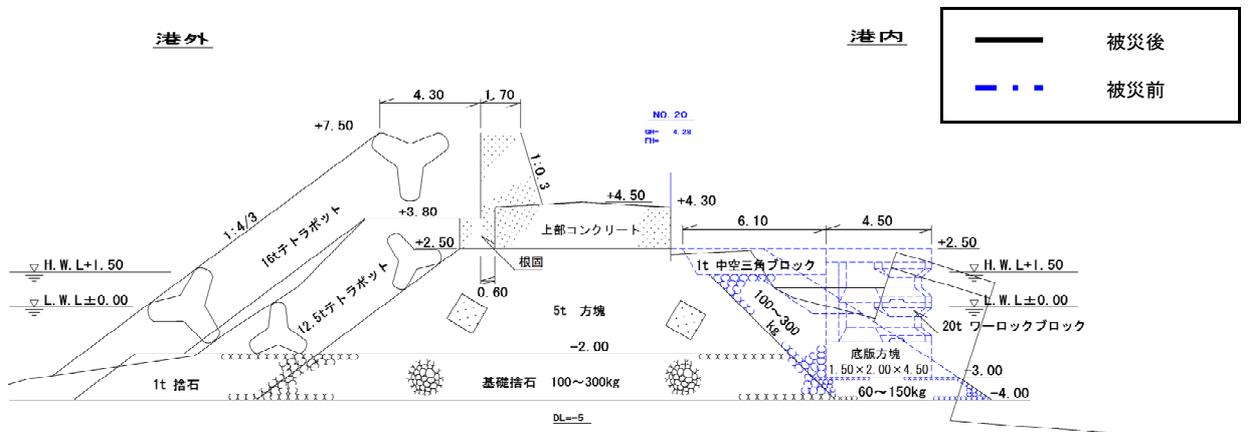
No.31 大洗港区_第1ふ頭 A-2 物揚場 (-4.0m) の断面図 (被災後)
